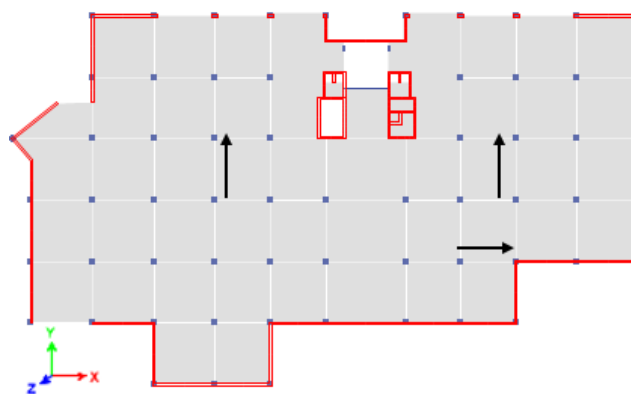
Esquema de ubicación de sensores en el subsuelo y Planta baja de la estructura. Instrumentación Básica.
